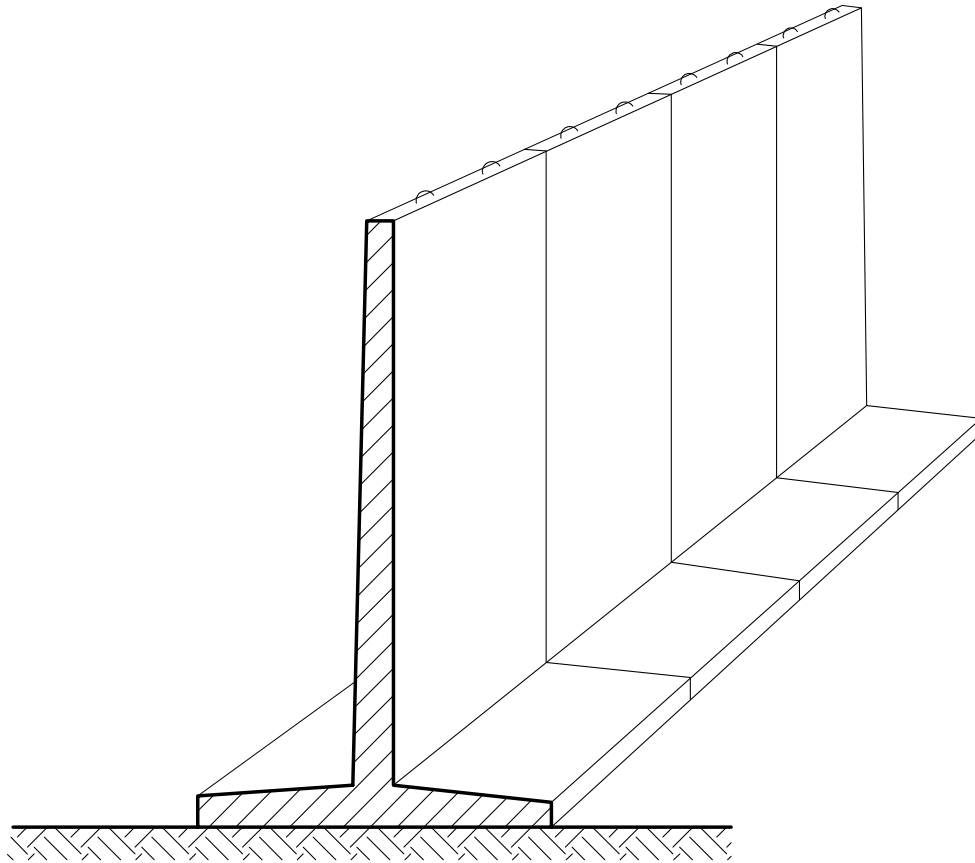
Stützwand aus Betonfertigteilen (T - Elemente)
